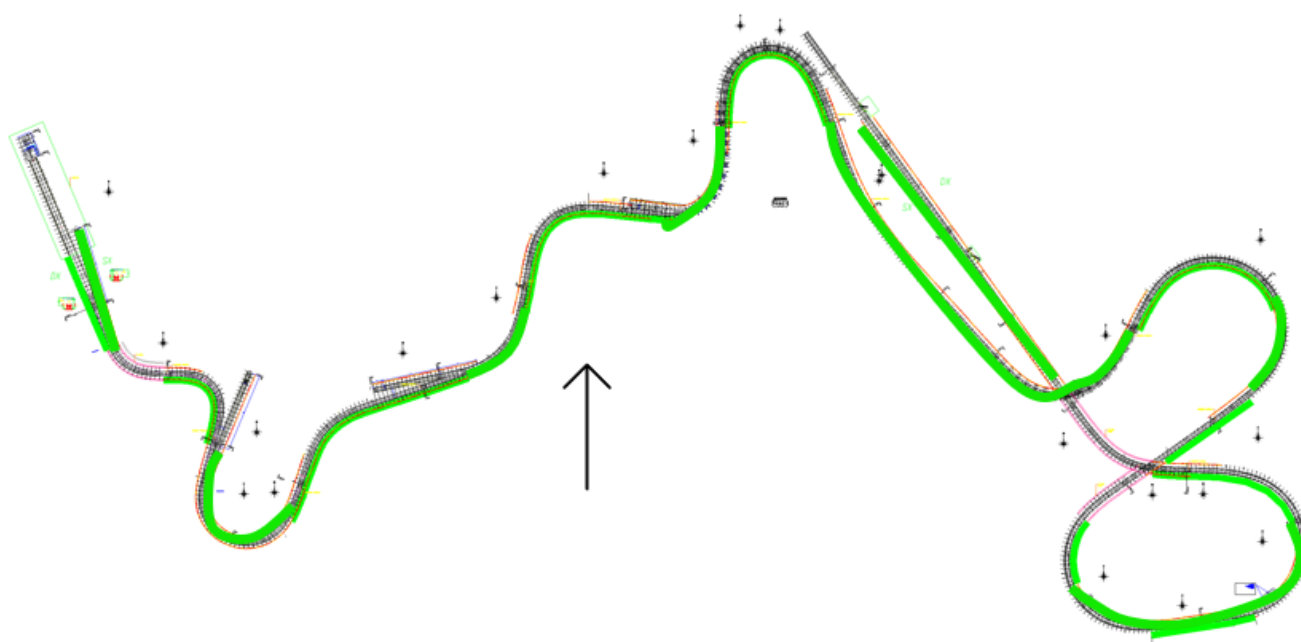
Schema della pista con le protezioni solari nelle zone esposte (in verde)
